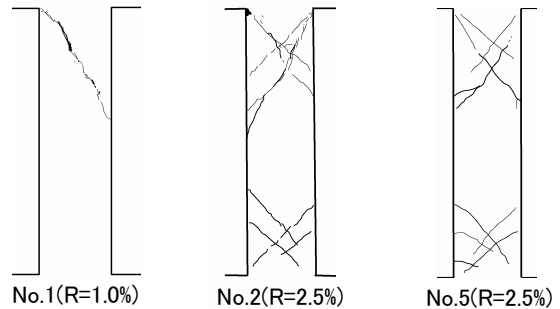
せん断破壊型柱終局時ひび割れ状況
